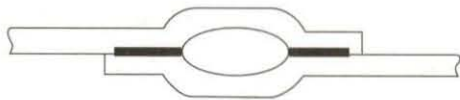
K416012-3 双缝热熔焊接焊缝示意图
